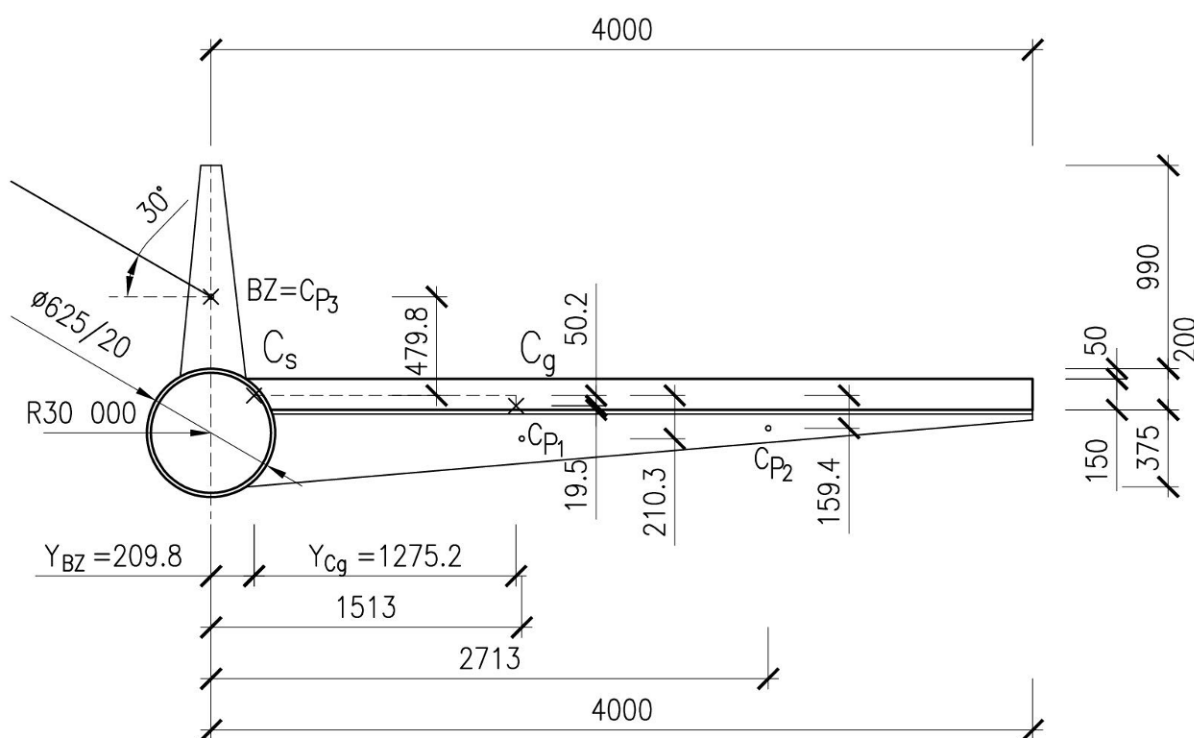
Schematický půdorys a pohled studie zavěšené konstrukce
